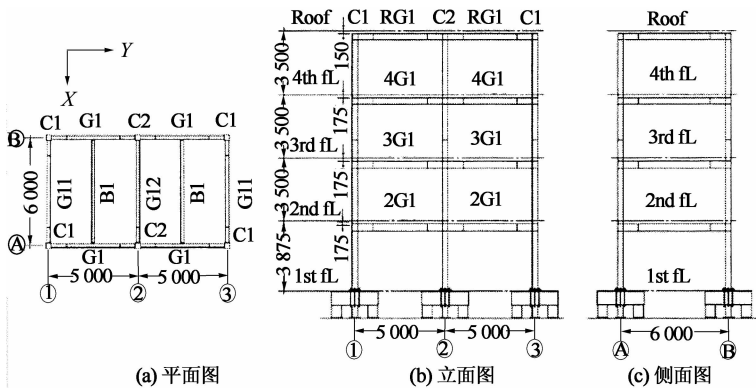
带蒸压轻质加气混凝土墙板钢框架结构平面及立面图
